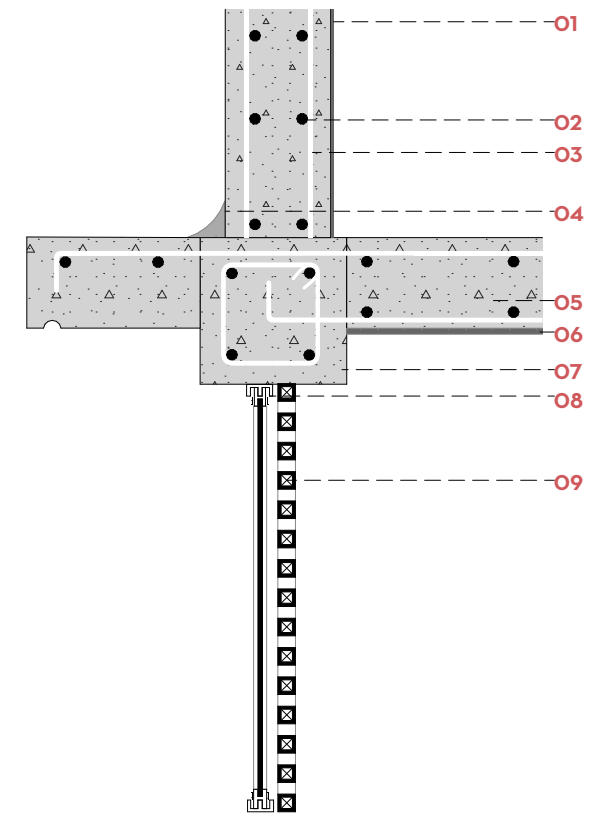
Detalle constructivo Fuente: Autoría propia.
